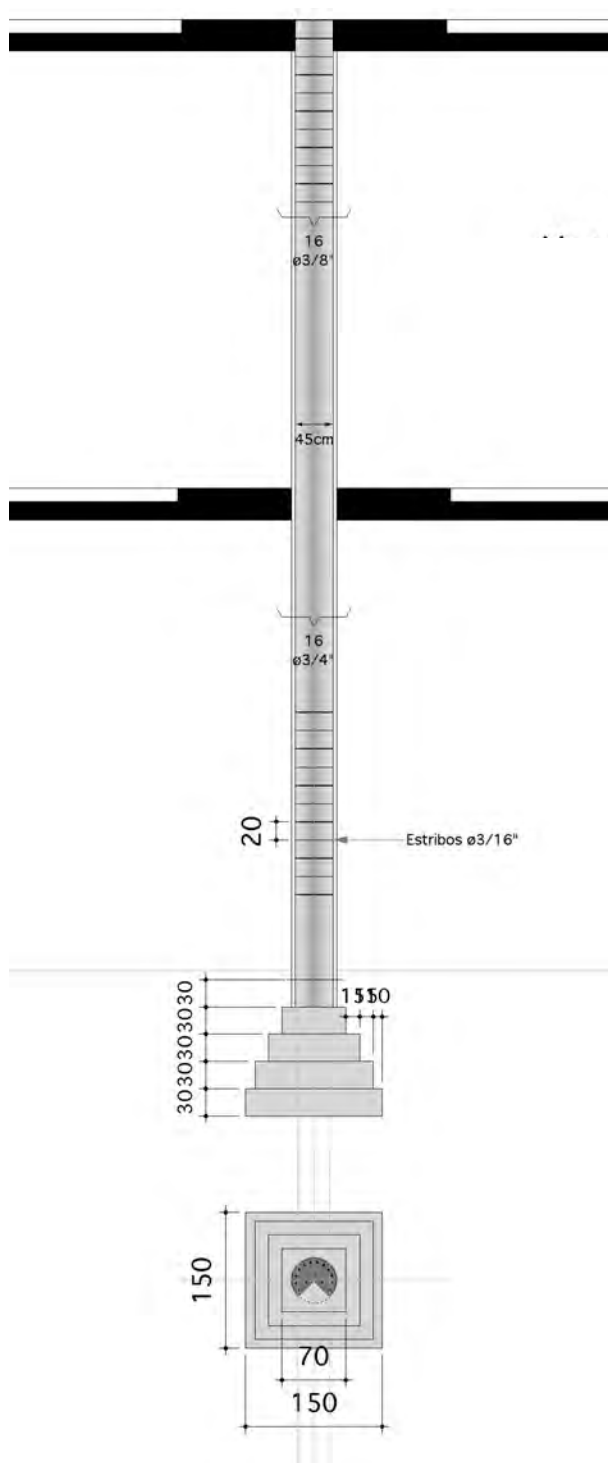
Esquema construtivo da execução de fundações, armaduras e seção de pilares do bloco de exposições. [Reprodução digital - Documento arquivado no IPHAN de autoria de Emílio Baumgart datado de 1936]: Arquivo Noronha Santos: Documento nº M6G6/ANS06230
